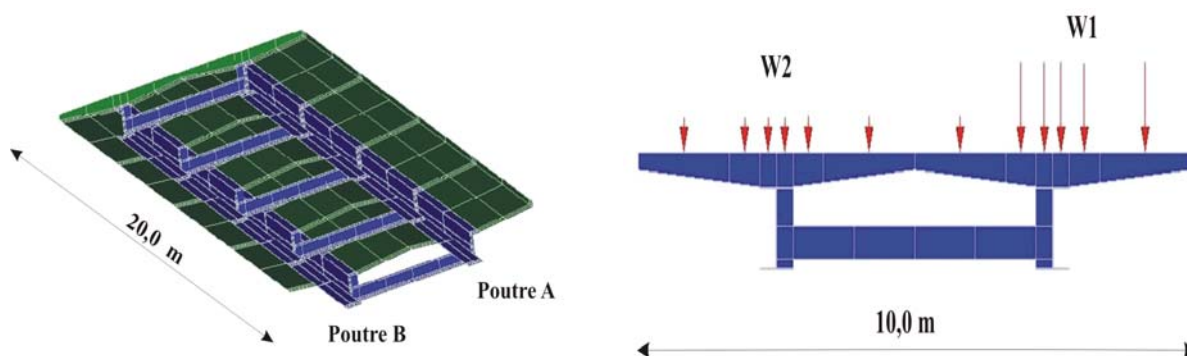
Modélisation tridimensionnelle du bipoutre mixte
